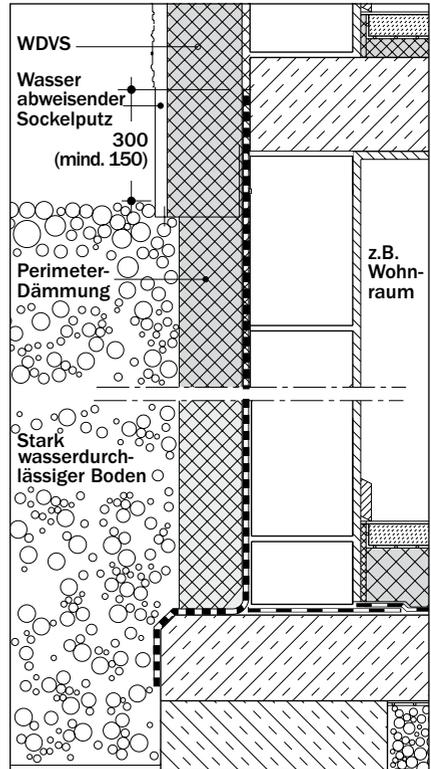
/11: Unterkellertes Gebau mit Wohnraum im Untergeschoss; Warmeschutz mit Perimeterdammung; Abdichtung durch KMB
